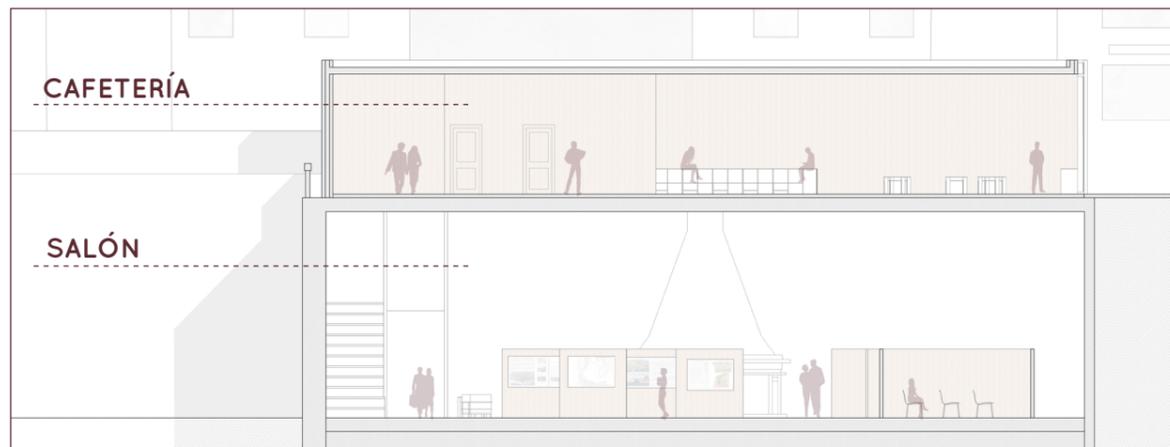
Sección que muestra la unión por las escaleras existentes de la cafetería y el salón.
